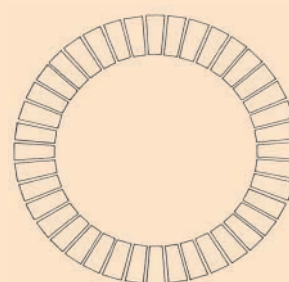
Arco pavimentado con adoquines cerámicos colocados a soga, o con pavimento a tizón.
